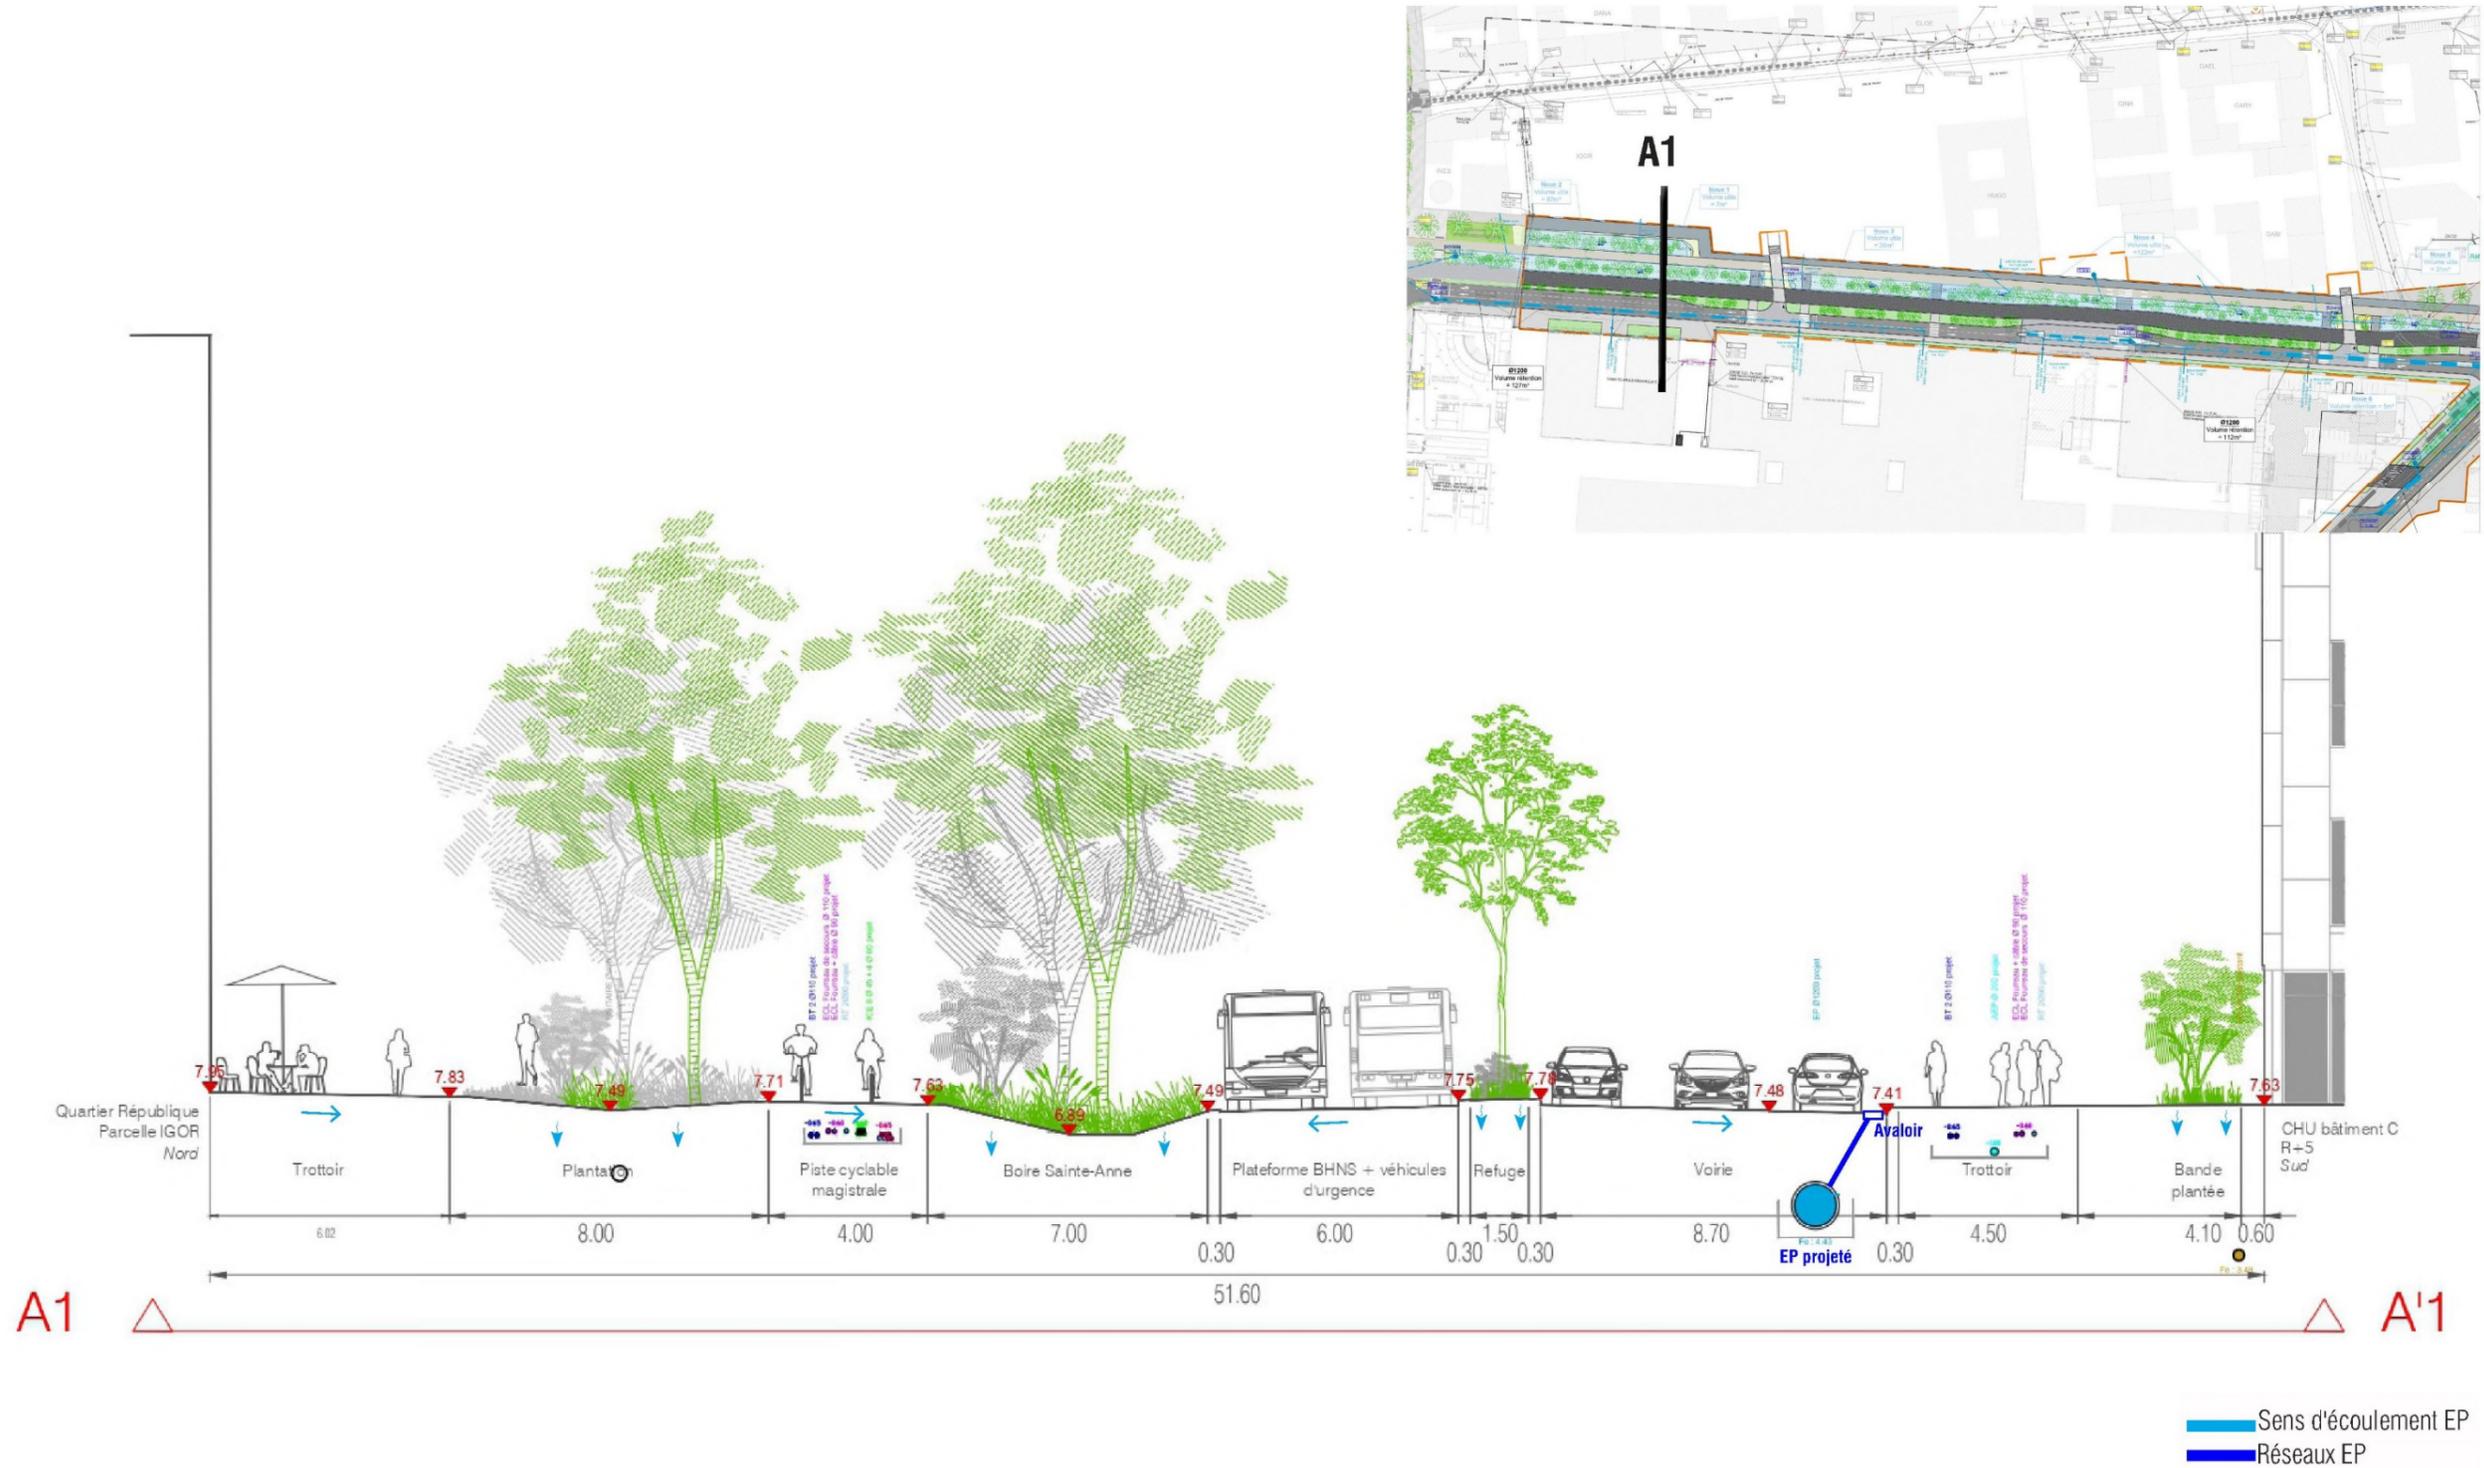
Principes d'assainissement – Boulevard Bénoni Goullin Ouest
